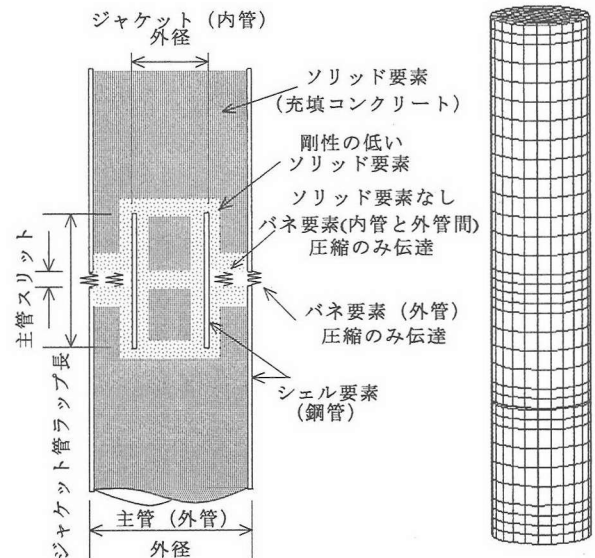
解析モデル概略図 図-8 メッシュ図 (基礎補剛部を除く)
